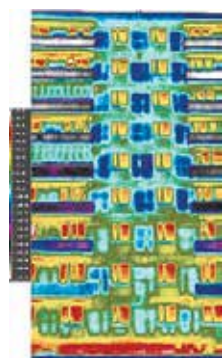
Термографическое изображение многоэтажного дома (наглядно демонстрирует теплопотери здания через конструкцию цокольного этажа) <http://www.irtis.ru/gal2.html>
